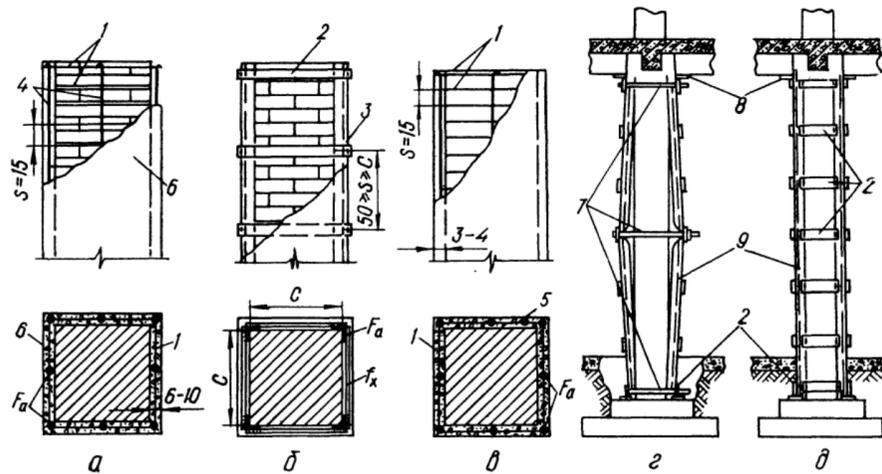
підсилення цегляних колон обоймами: а- залізобетонний; б- сталлюю; в- армованою штукатуркою; г- загальний вид із кутів до закінчення робіт; д- загальний вид після закінчення робіт, 1- хомути; 2- планки; 3- сварка; 4- стрижні; 5- штукатурка; 6- бетонна суміш; 7- стягуючий болт; 8- опорна плита; 9- стійка із кутиків.
